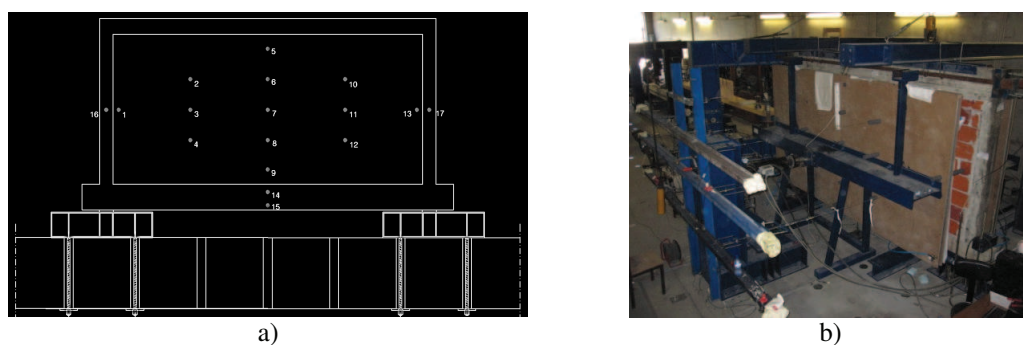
Instrumentação para fora do plano: a) Esquema; b) Vista geral
